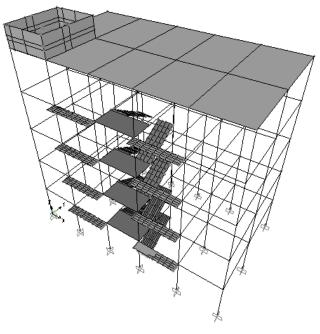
MODELISATION DE LA STRUCTURE AVEC RESERVOIR (POSITION 1)
